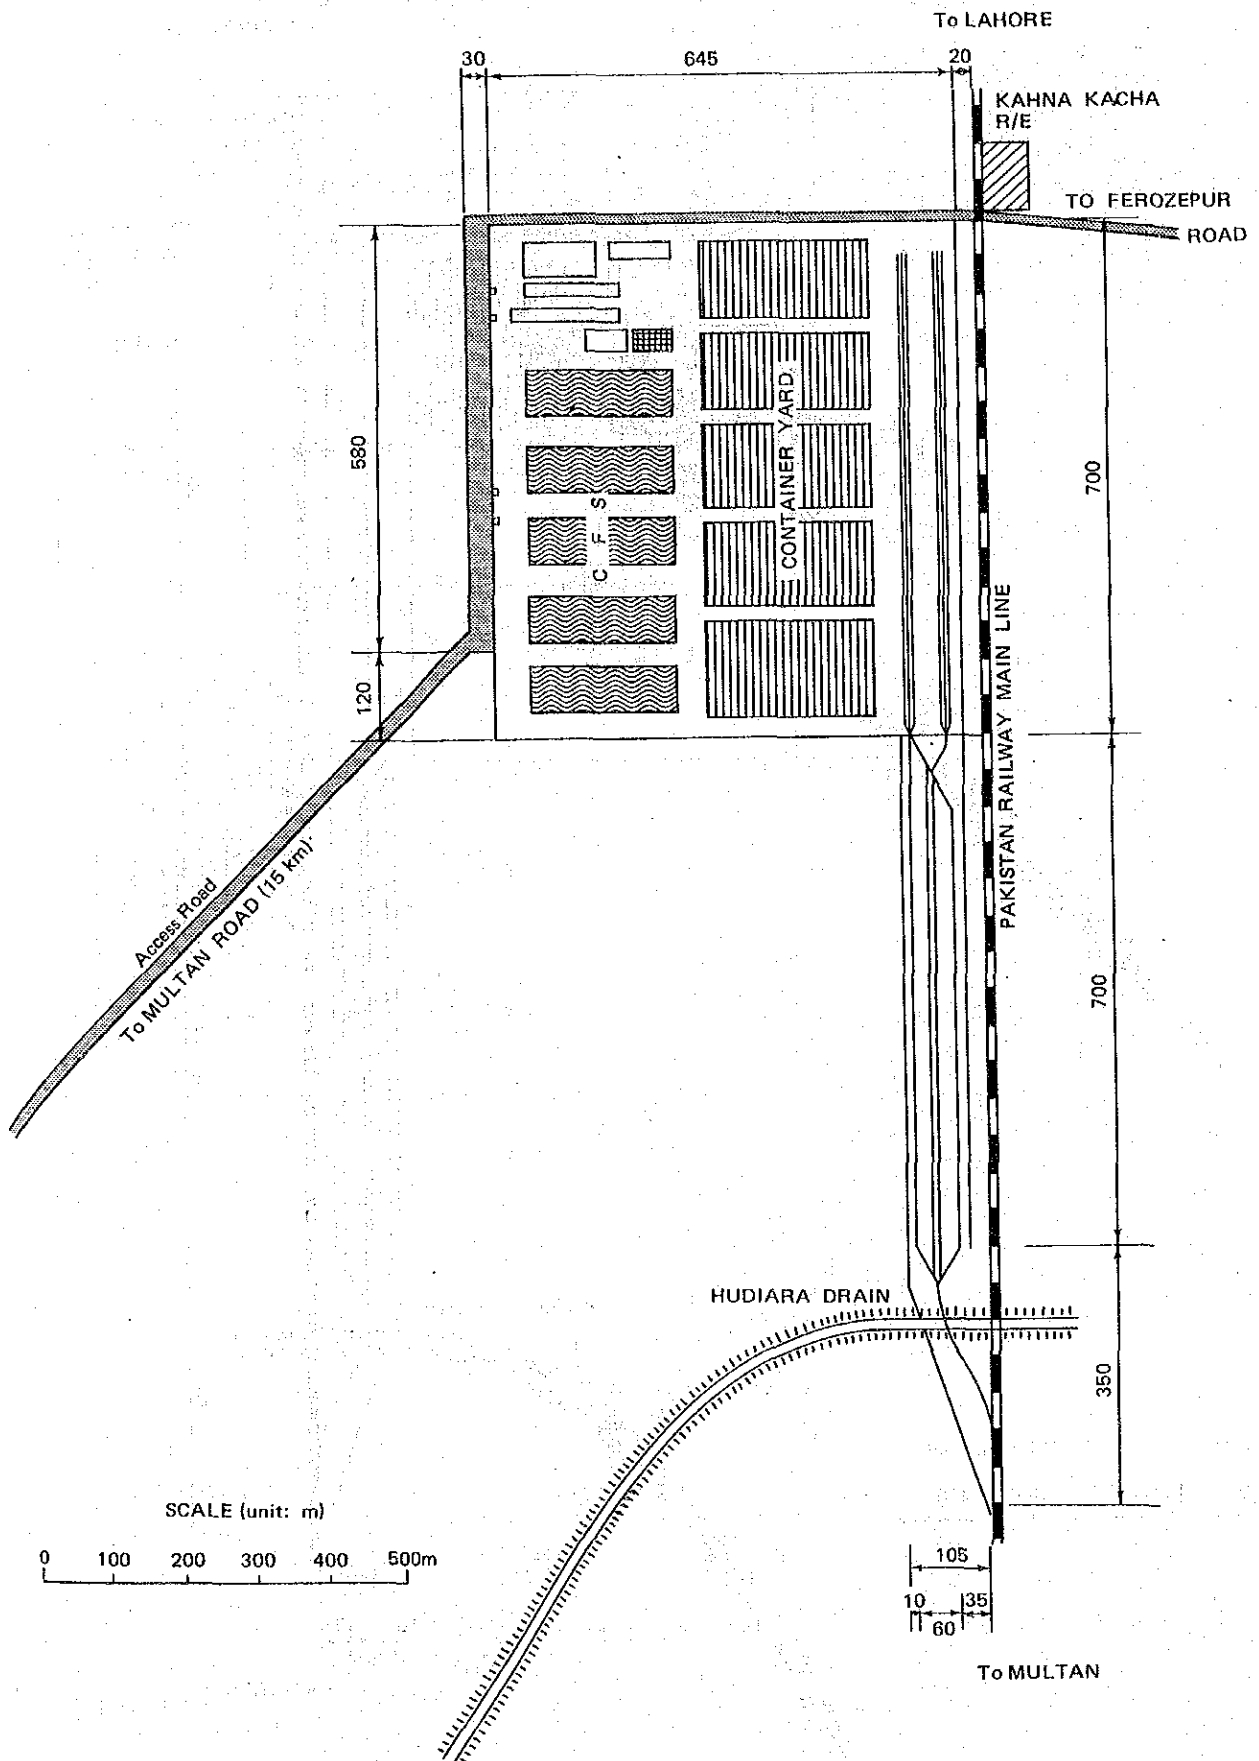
内陸コンテナ・フレート・ステーション平面図 (基本計画)
